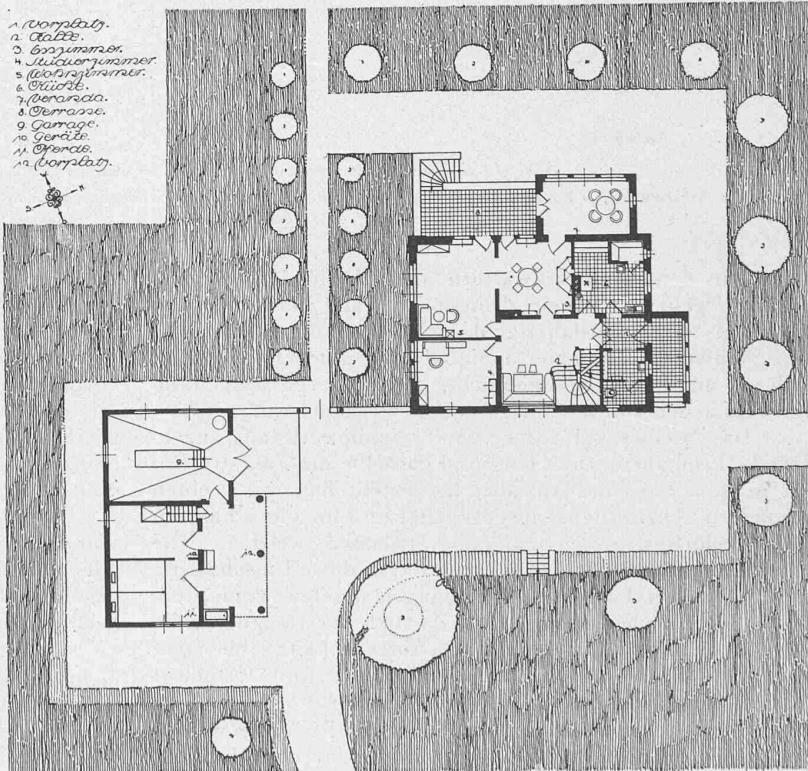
Erdgeschoss-Grundriss mit nächster Umgebung. — 1:400.
